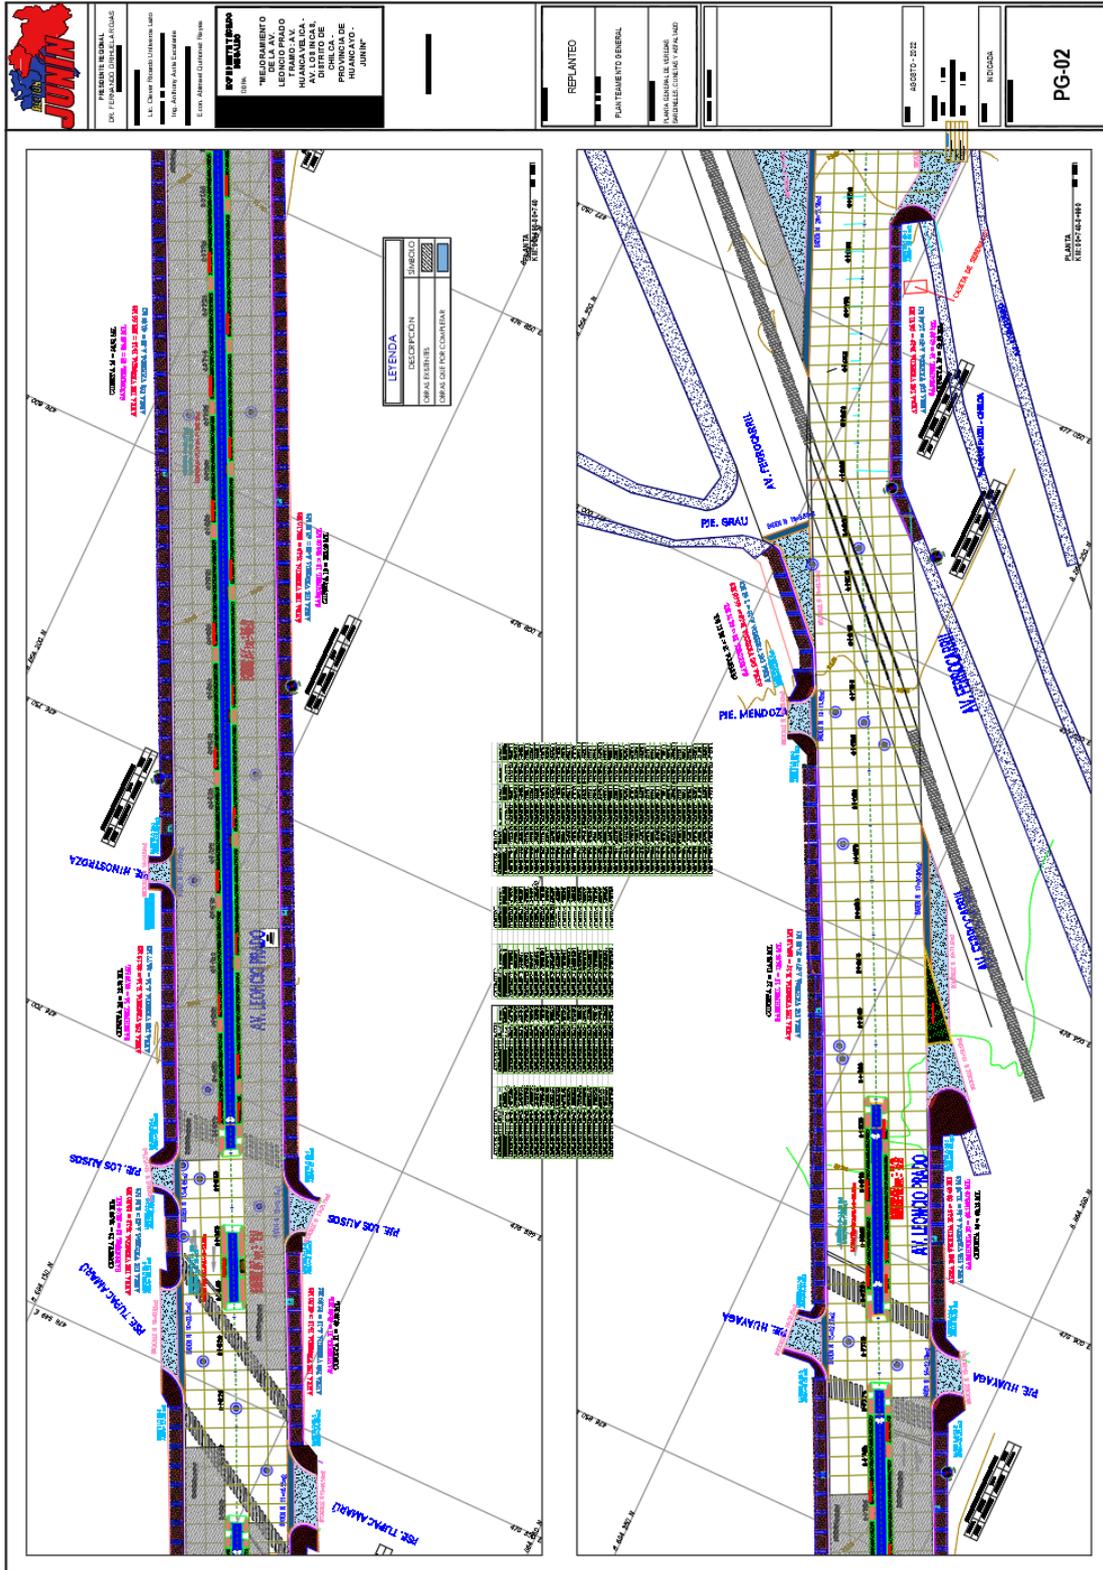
Plano del planteamiento general 02 de la obra CUI 2310610
